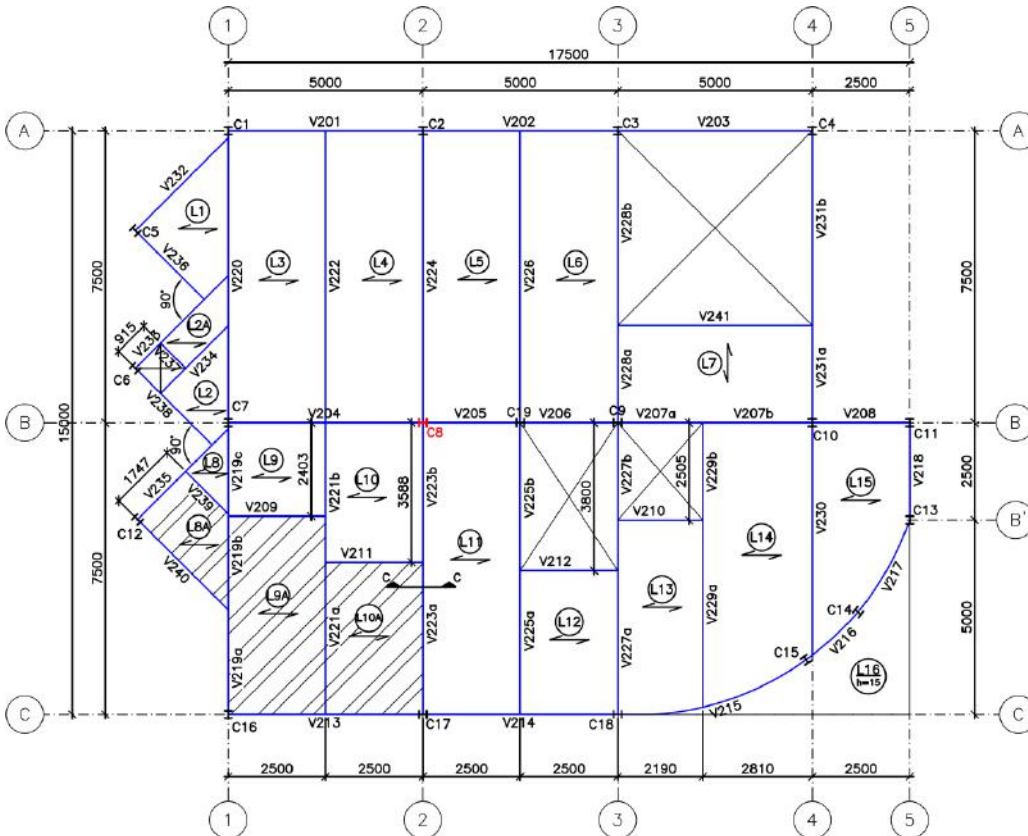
Plano das vigas – EL:+5900mm (2º Pavimento) – Dimensões em mm
